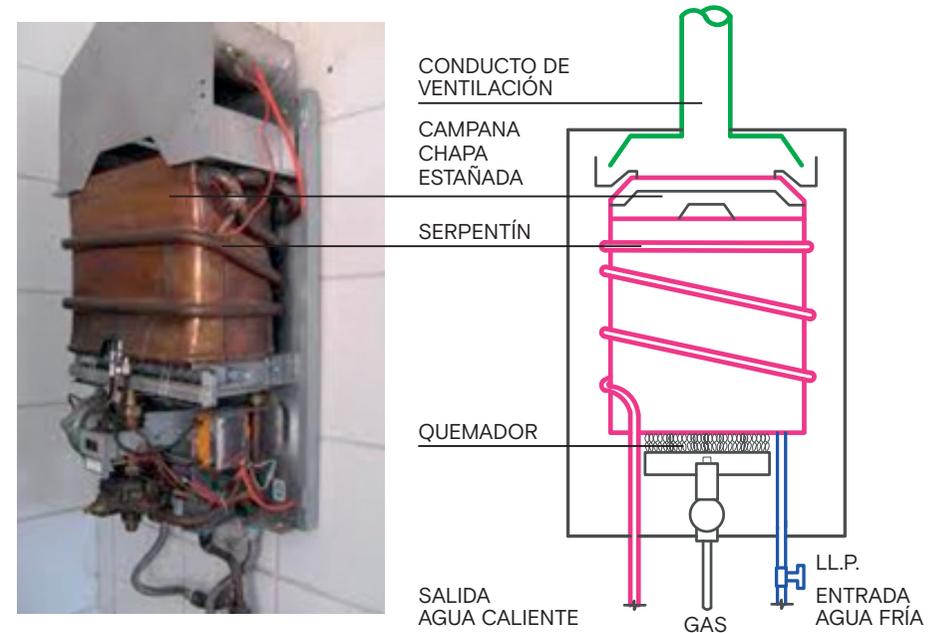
Calentador Instantáneo: Intercambiador de calor. Esquema de componentes.
